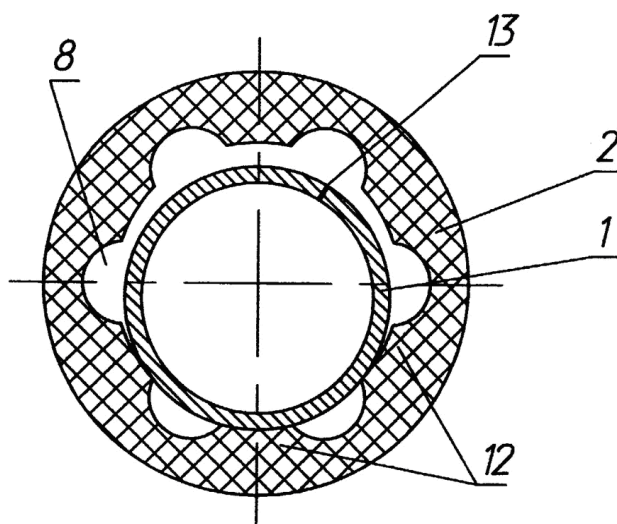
Поперечный разрез оболочки и трубопровода: 1 – секция трубопровода; 2 – изоляционная оболочка; 8 – межтрубное пространство; 12 – опорные элементы; 13 – продольный шов
